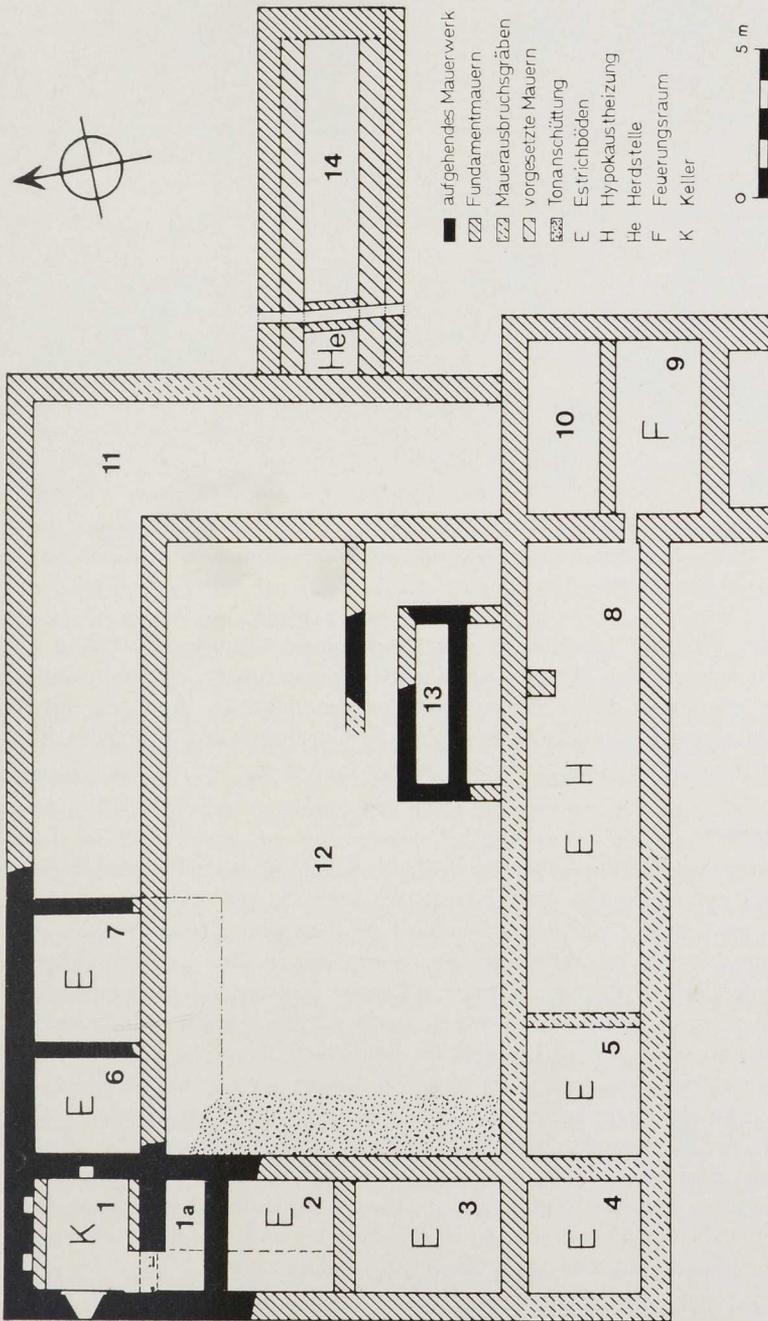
Bad Rappenu-Zimmerhof, Kreis Heilbronn. Grundriß des Villengebäudes.
